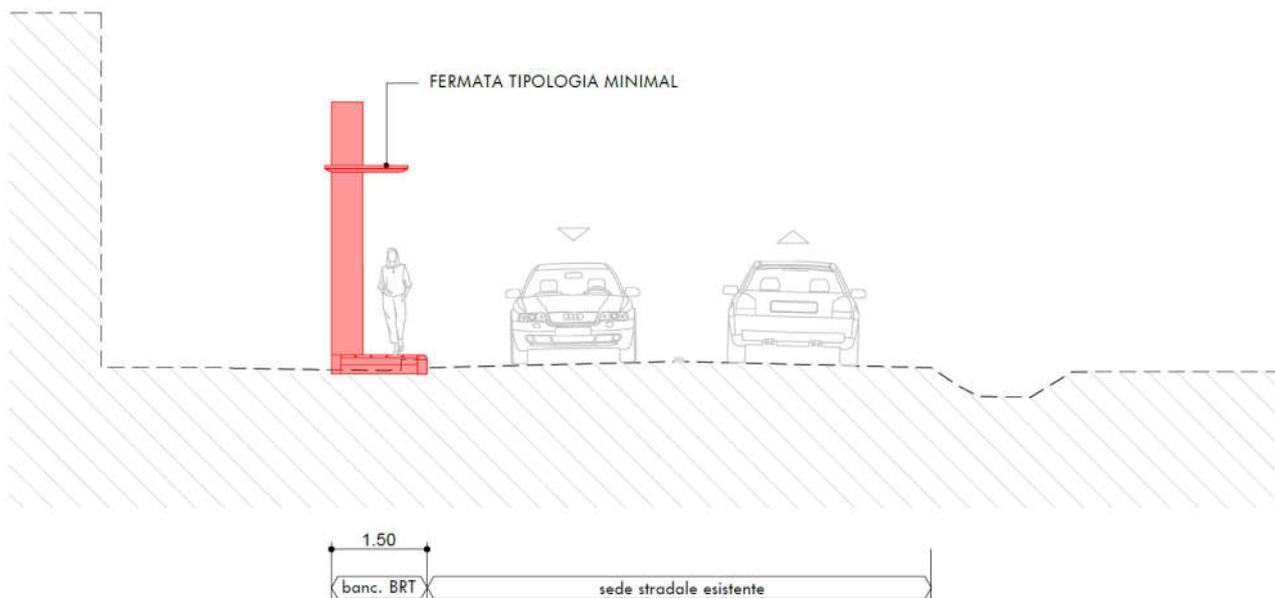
Fermata Armarolo. Sezione Tipologica 2.
